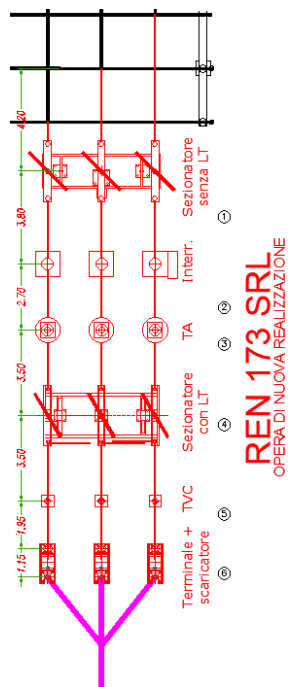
Planimetria elettromeccanica nel nuovo stallo AT
